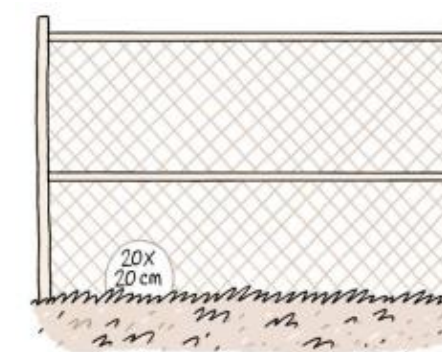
Passage à faune de 20 cm² sur grillage à mailles fines. (Source : Bruxelles Environnement)
